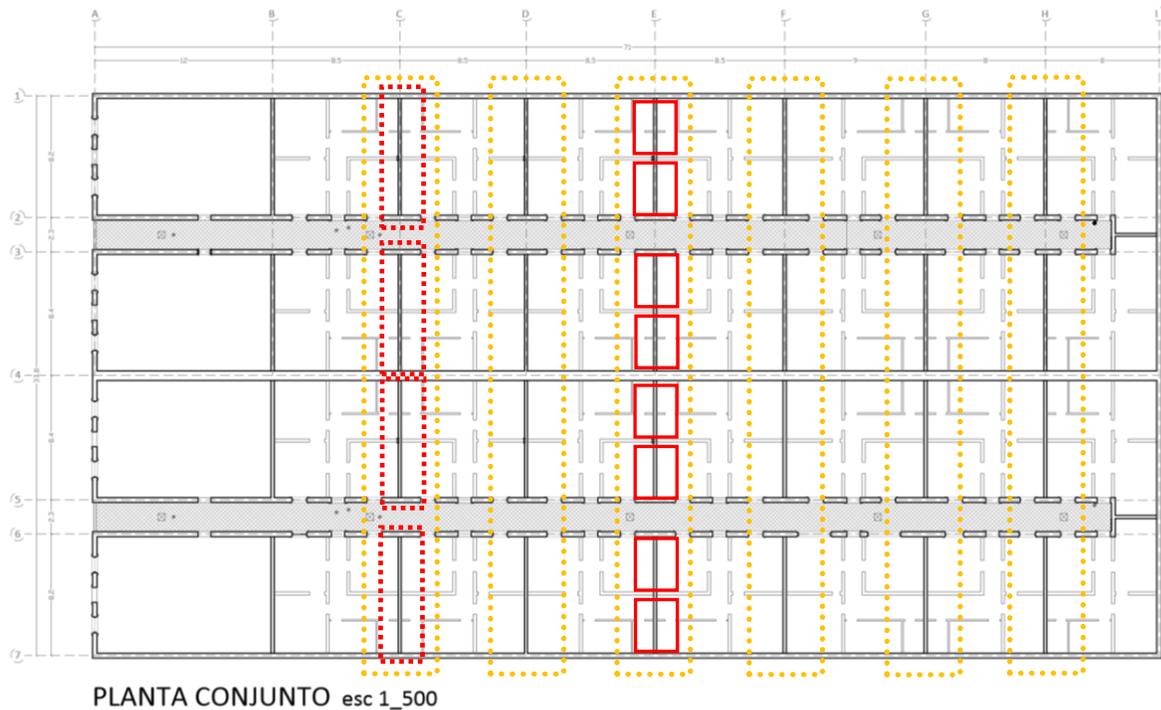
Plano de conjunto intervenido donde se indican en color rojo los muros más propensos.
